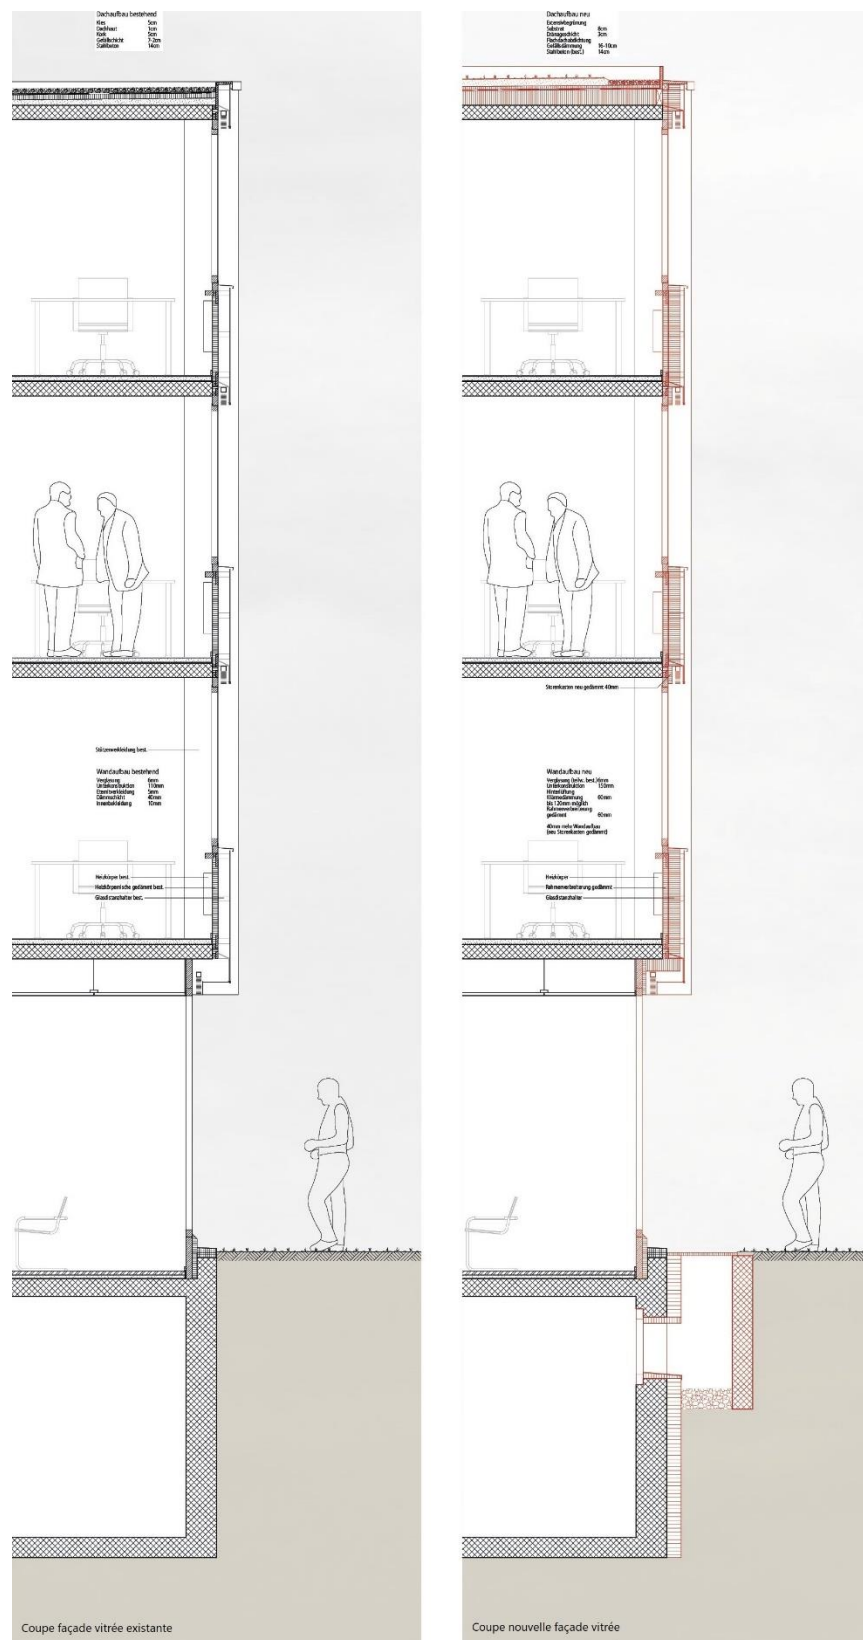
Coupe façade existante et coupe nouvelle façade
